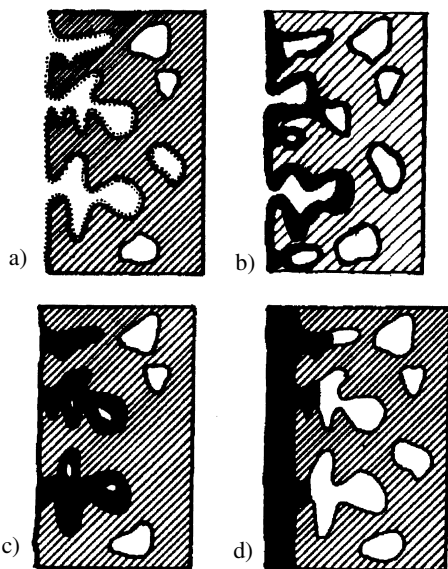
Základní typy poruch vrstevnatých konstrukcí
